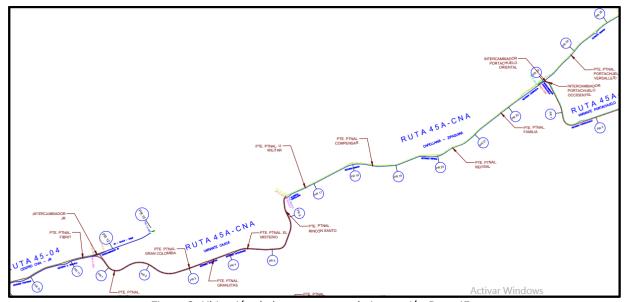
Ubicación de las estructuras de inspección Ruta 45.
